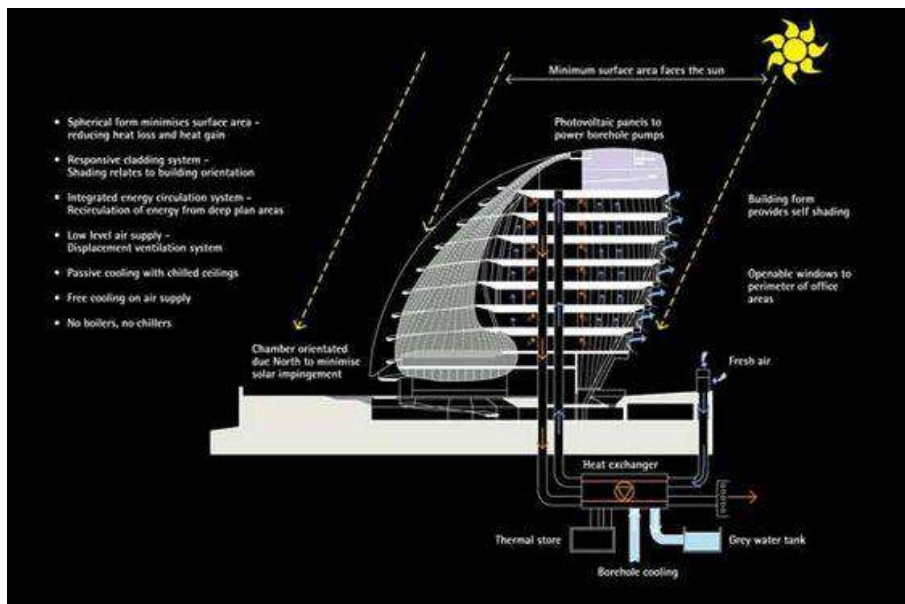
Ayuntamiento de Londres. Fuente: Foster and partners
